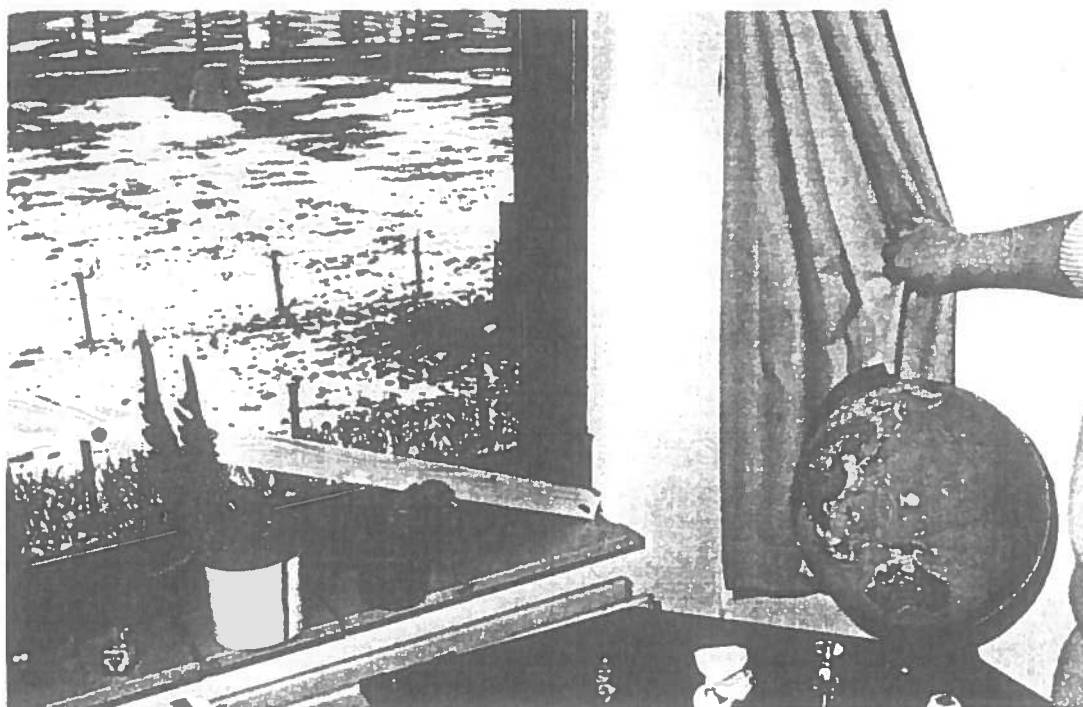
Zolwijkseweg 4, gespleten kozijn, afstand 900m.
